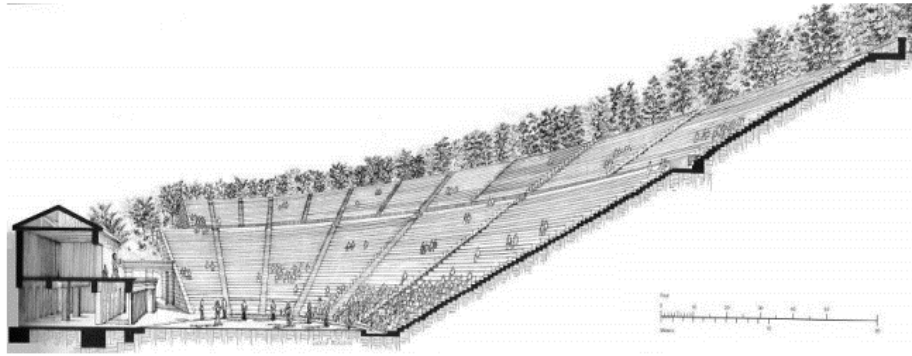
Sección Teatro Griego Epidauro. Adaptado de Theater design.
